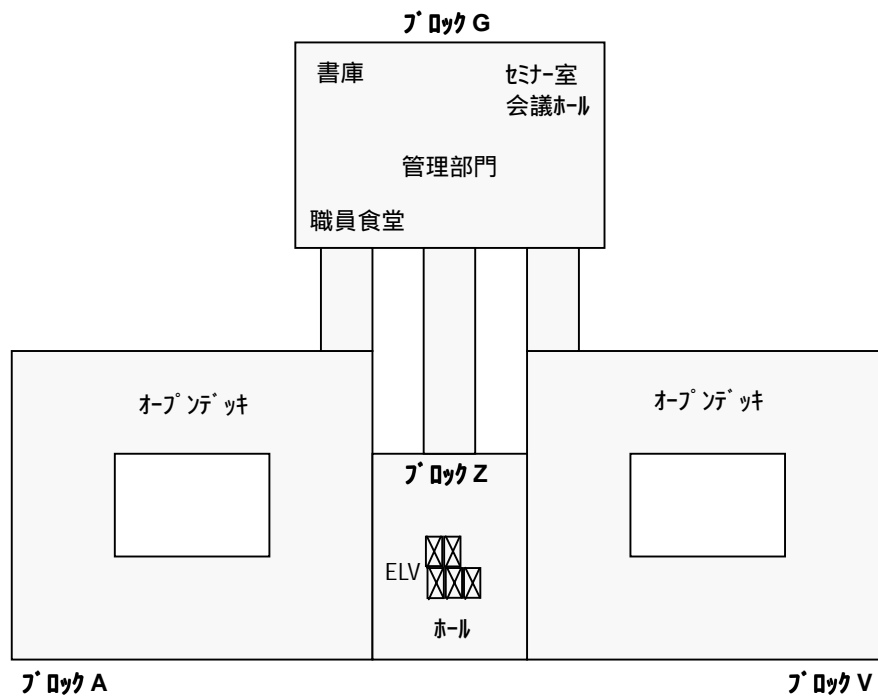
(その 1) グドウシャウリ総合病院地階平面図
